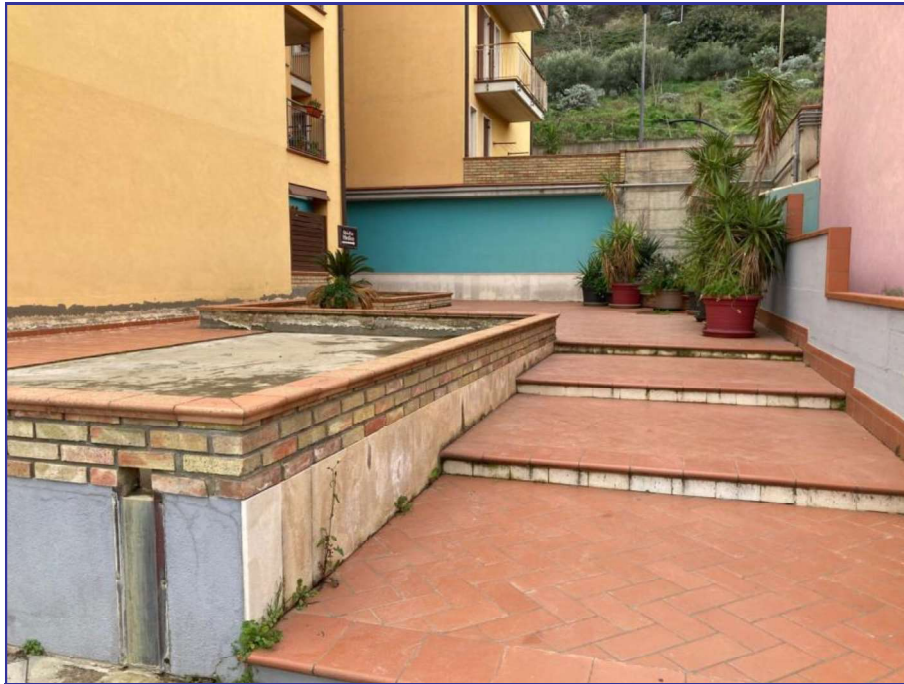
Imm.1 - Area esterna che dalla strada della lottizzazione permette di raggiungere il vano scale/ascensore per l'accesso all'appartamento (area bene comune non censibile part. 1163 sub. 1)
